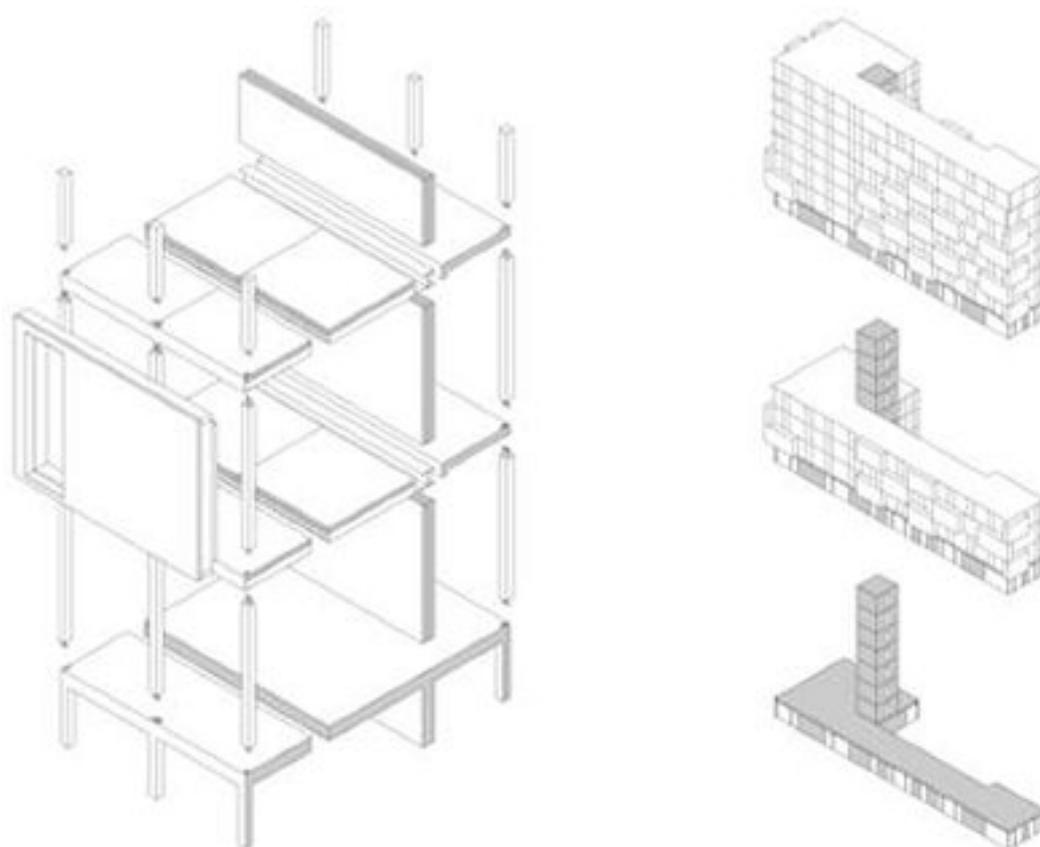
Hybride Bauelemente / hybride Bauwerke, aus: Atlas mehrgeschossiger Holzbau, S. 42
